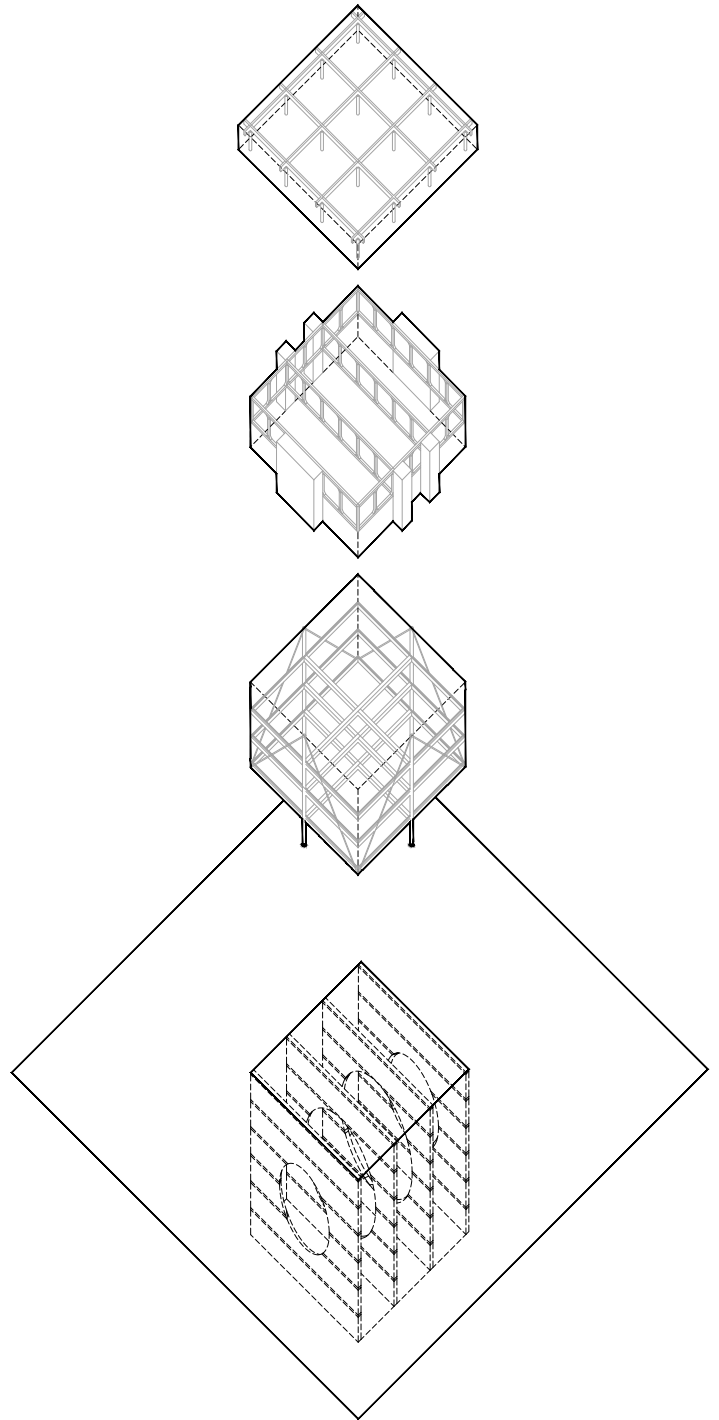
Esquema, apilamiento de sistemas estructurales. Fuente: Elaboración propia.
